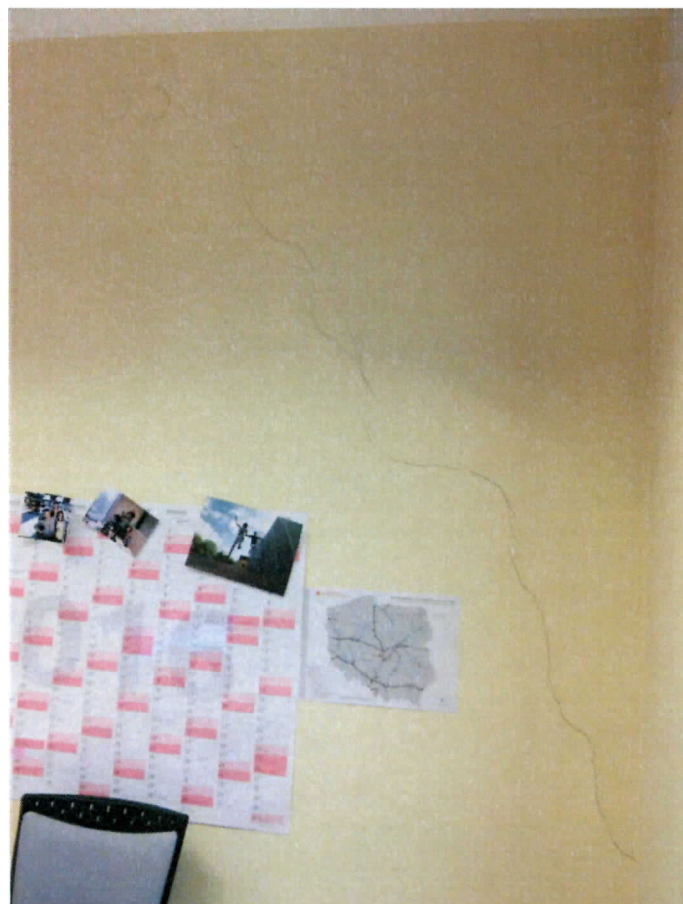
Widok powierzchni do malowania w pomieszczeniu socjalnym na parterze. Konieczność montażu zewnętrznego parapetu ze spadkiem na zewnątrz budynku.
